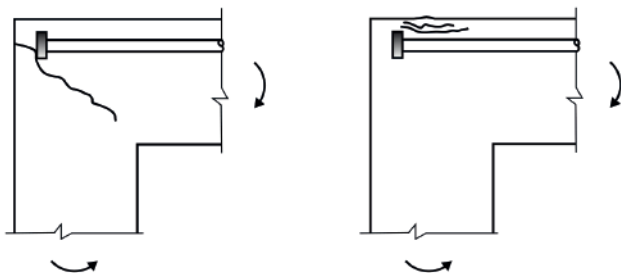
Mecanismos de falla potenciales en los nudos de esquina con barras corrugadas con cabeza: (a) Agrietamiento en diagonal; y (b) desprendimiento del concreto en la cara superior del refuerzo
